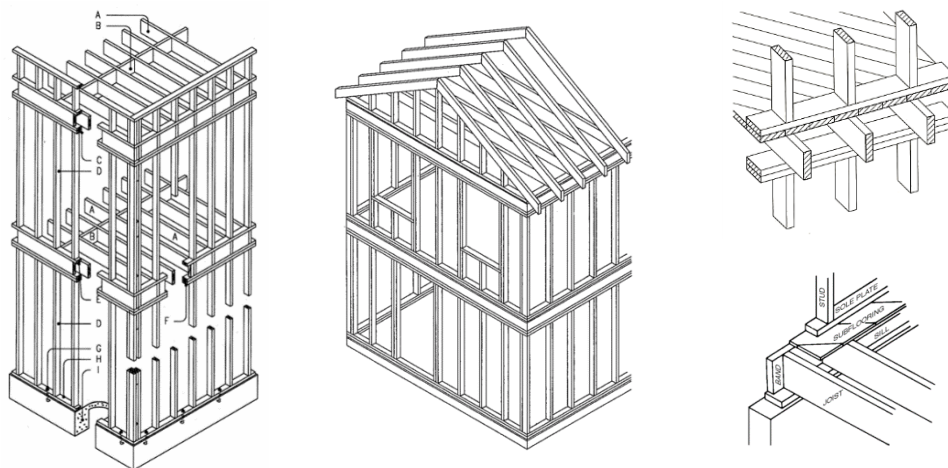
Reticulados leves "platform frame". Cobertura plana, cobertura inclinada, pormenores do piso intermédio, pormenores do pavimento térreo sobre paredes de betão (Schierle, 2006) (Deplazes, 2005a) (Herzog, Natterer, Schweitzer, Volz, & Winter, 2008) (Watson, Crosbie, & Callender, 1999).
